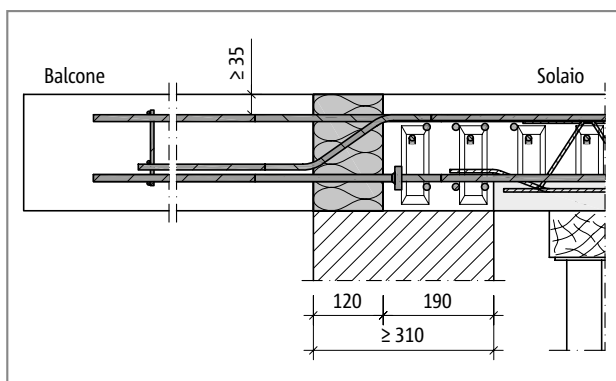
Schöck Isokorb® tipo EXT: soletta dell'elemento con supporto sul bordo e muratura termoisolante (sezione EXT-L-CV35; vista EXT-R-CV50)
